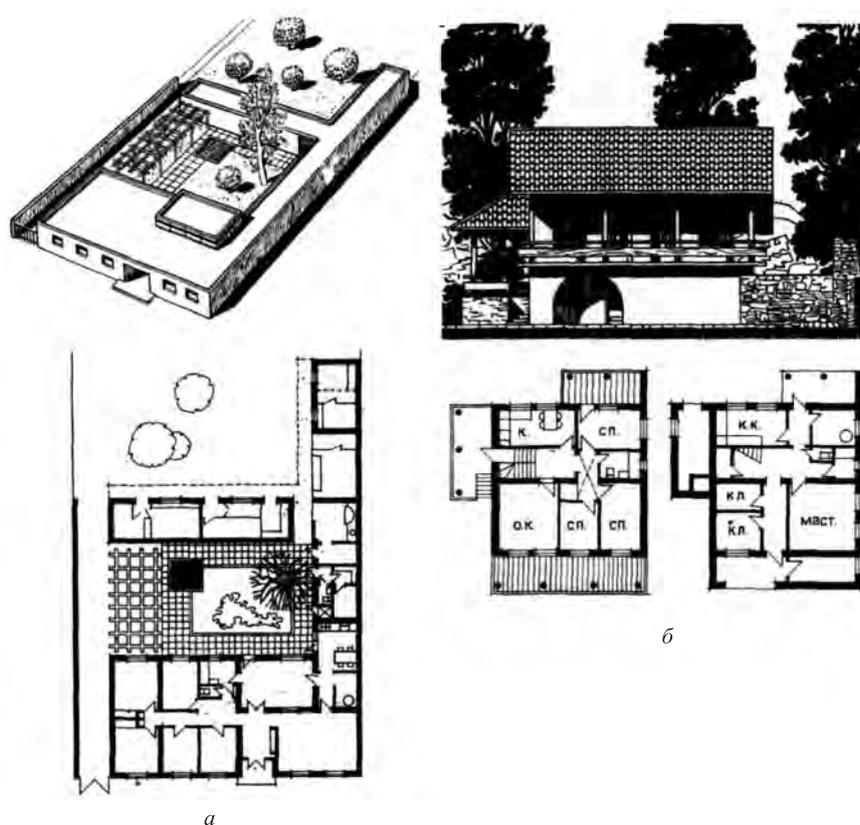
Южный усадебный дом: *а* — жилой дом с развитым дворовым пространством для южных районов Средней Азии, общий вид, план этажа; *б* — двухэтажный дом для юга России, планы этажей, фасад
